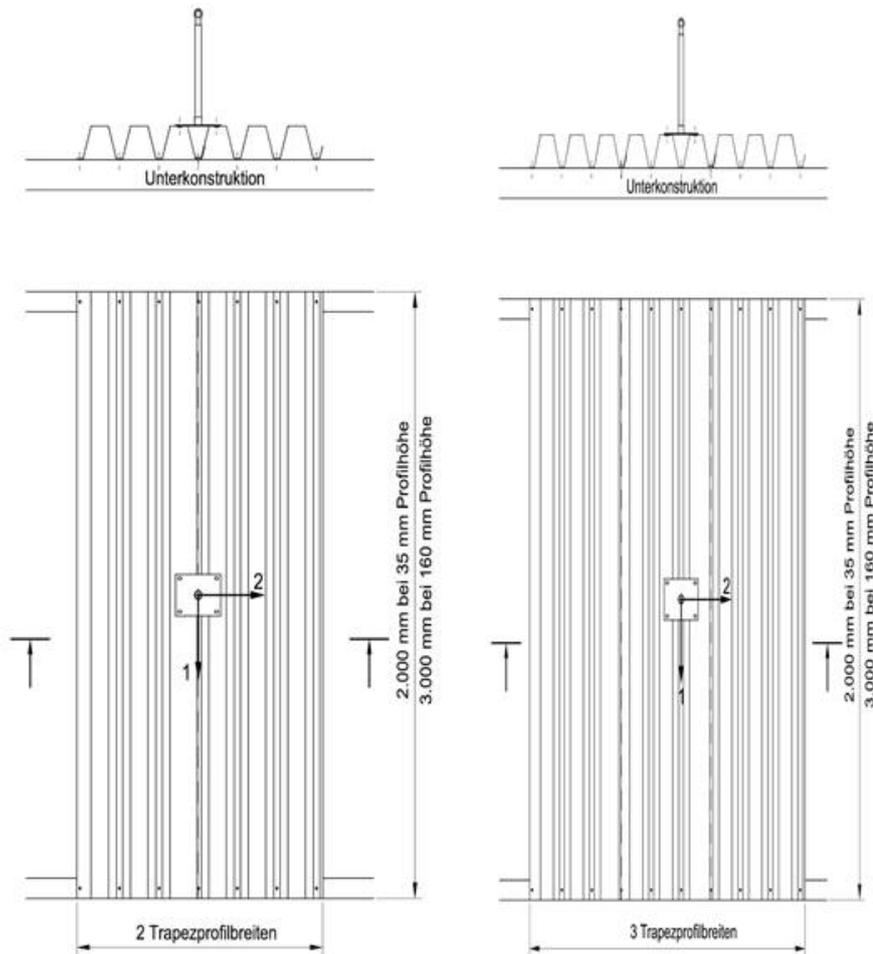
Anwendungsbereich auf Stahltrapezprofil (Positivlage)
